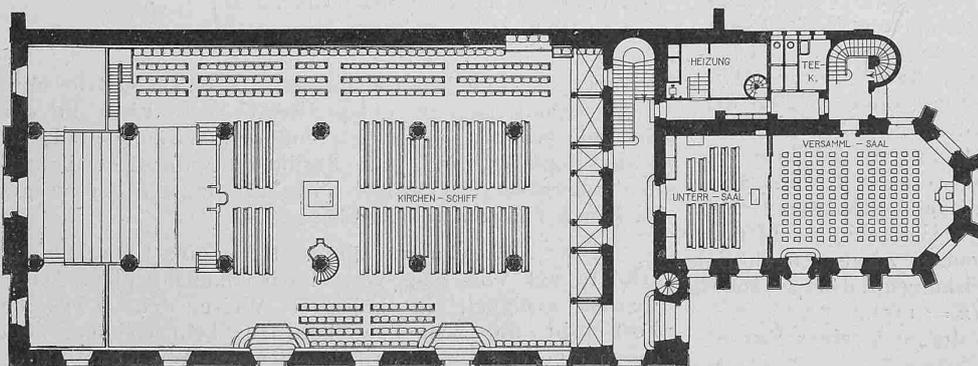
Grundriss der Welschen Kirche in Bern.
